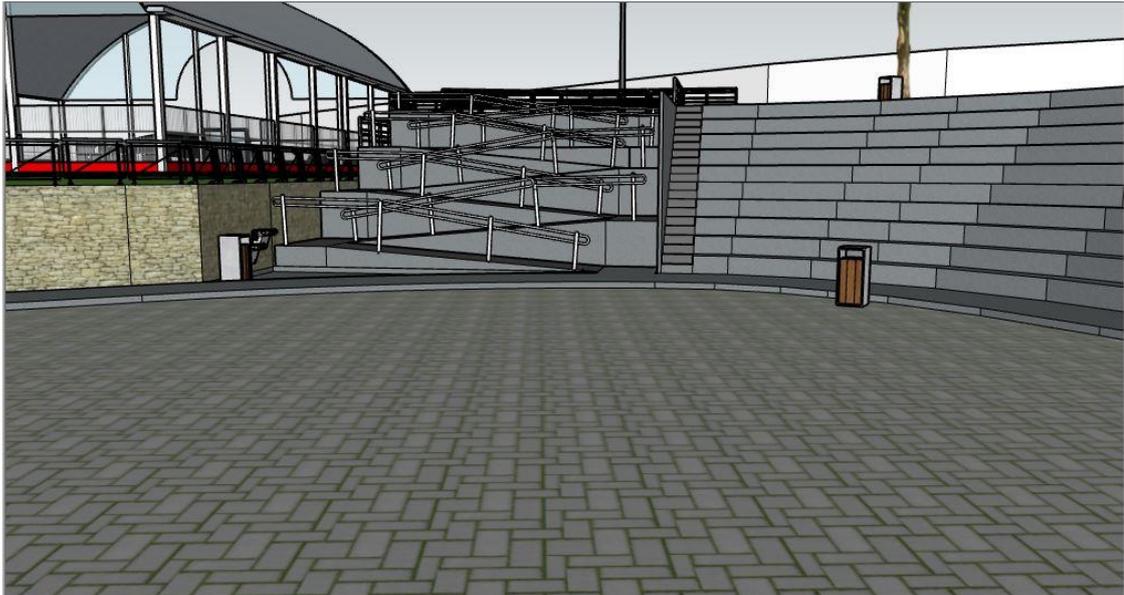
Vista do bloquete intertravado e rampa de acessibilidade.
